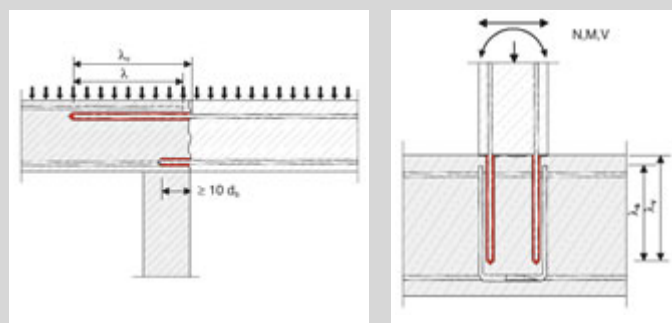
Ampliación de secciones de losas o vigas con solape de barras existentes.
